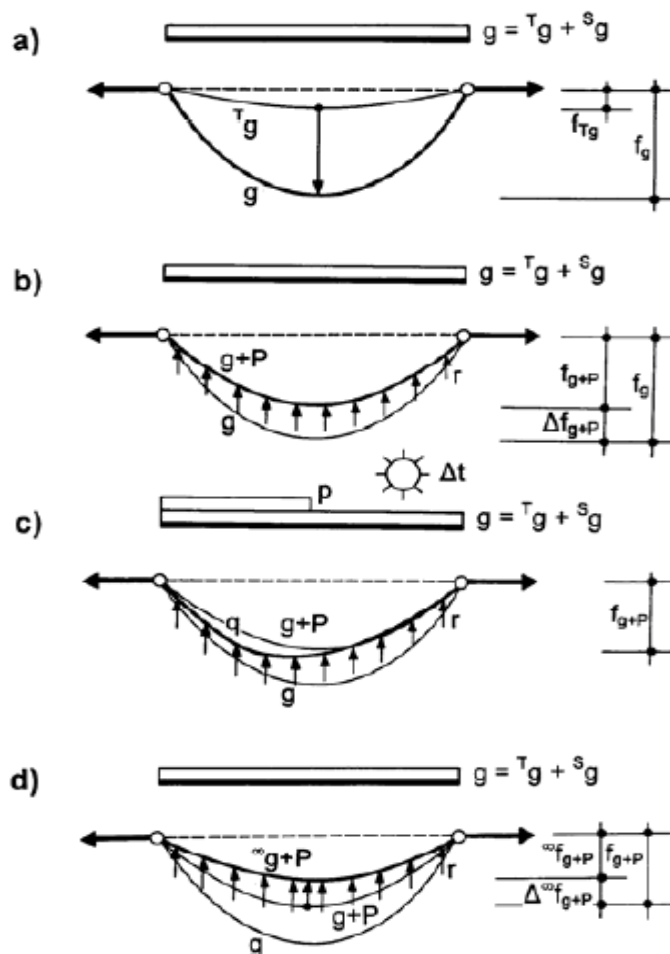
Carregamento e deformação em pontes *stress ribbon* construídas por elementos pré-fabricados:
